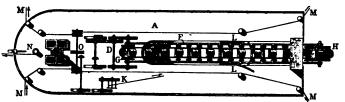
Eimerkettenbagger. Grundriss.
